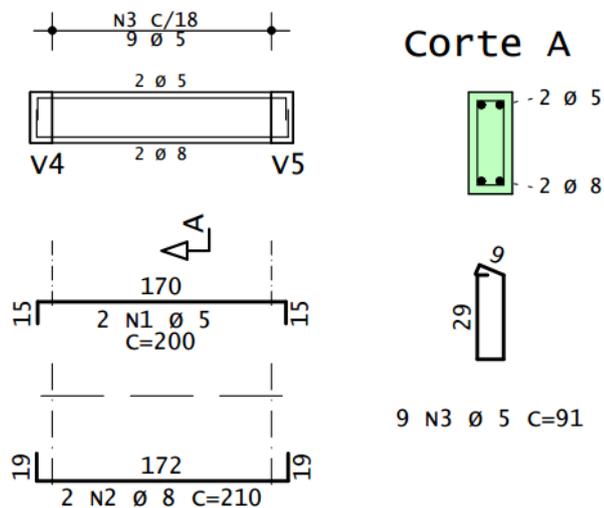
Armadura da viga V1 – pavimento superior (nível +3,00)
